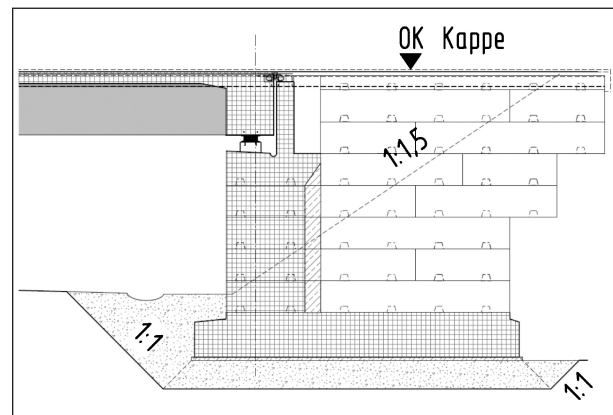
Schnitt Widerlager, Modulbauweise mit Blocksteinen (Breite 3 m)
